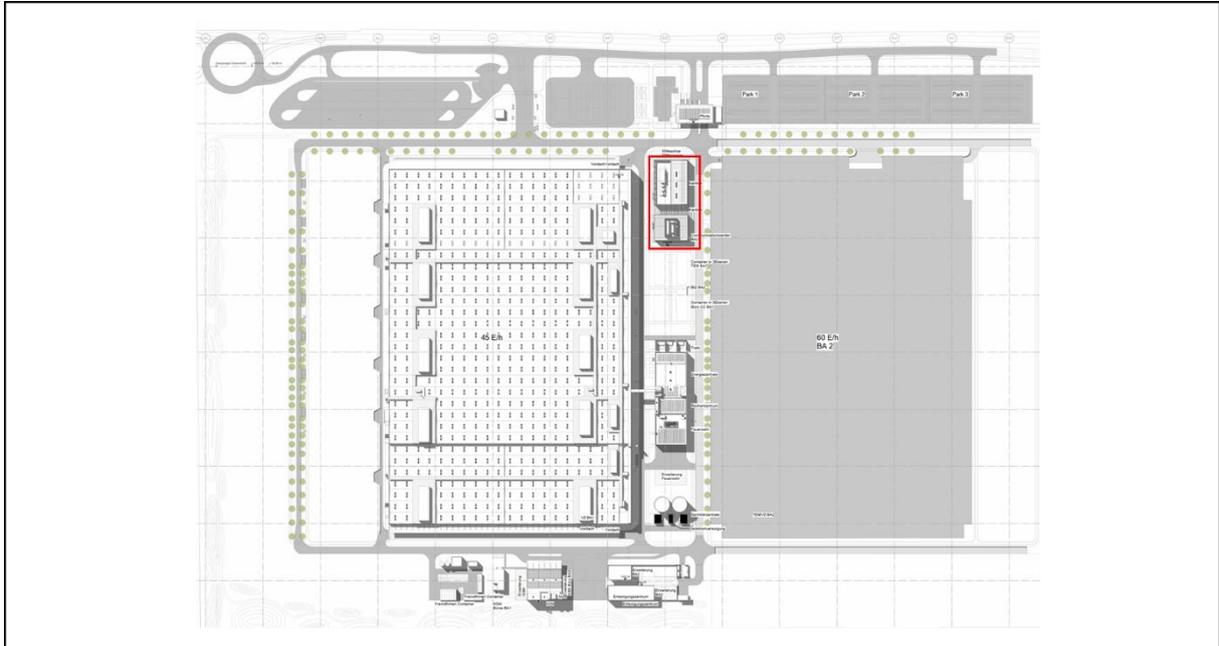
Communication Center - Lageplan Dachaufsicht.
